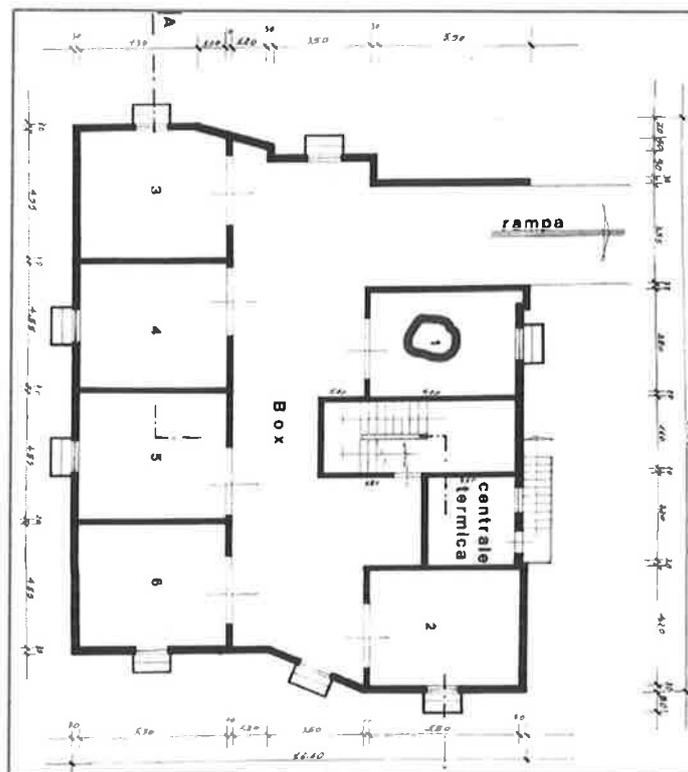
Estratto progetto piano S1 edificio A – evidenza box n.1.
